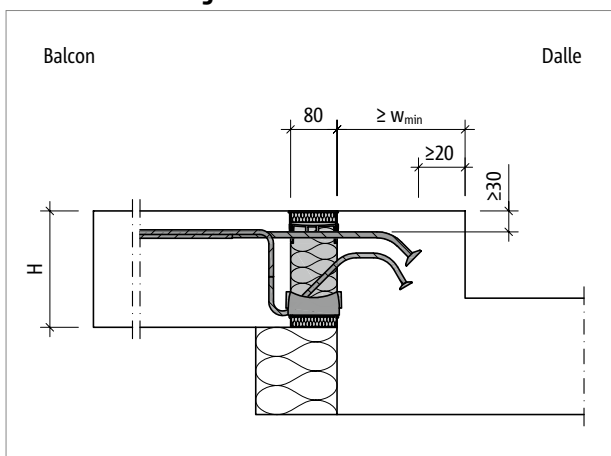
Schöck Isokorb® T type K-O : balcon avec décalage vers le haut et isolation extérieure
